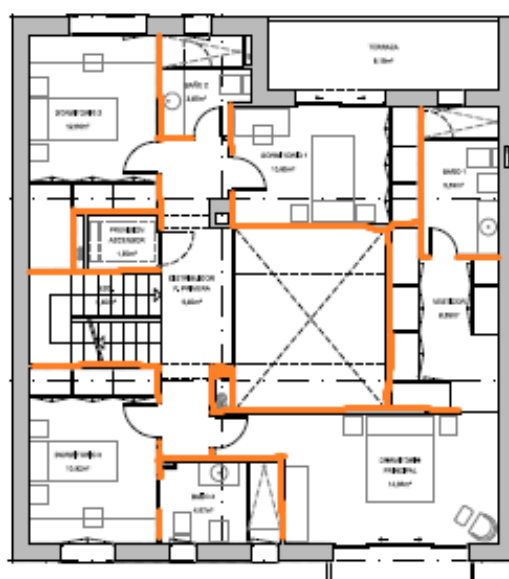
Tabiques interiores en la primera planta de la vivienda
